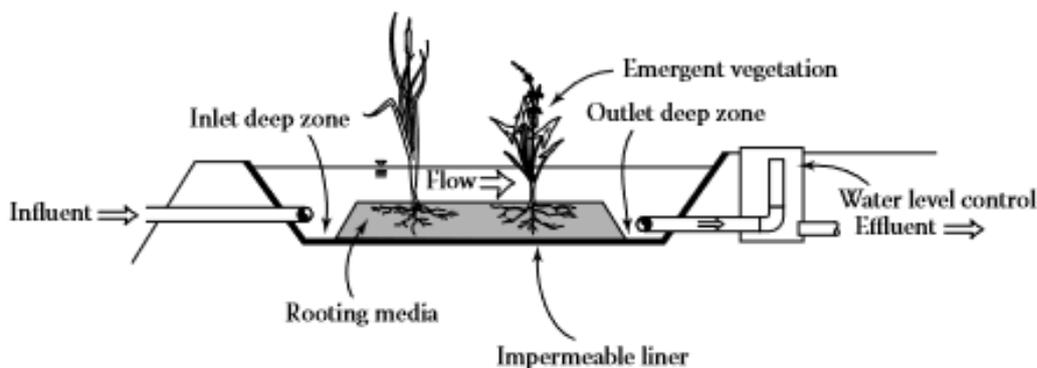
Grundelemente einer FSW (KADLEC und WALLACE, 2009)
